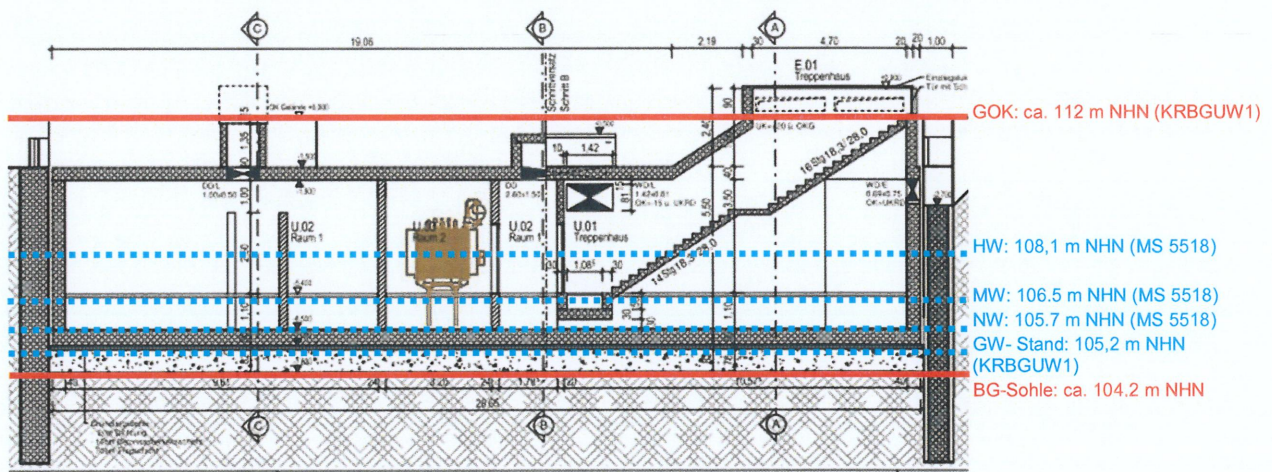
Auszug aus Bauwerksübersichtsplan inkl. GW-Stände (Anlage 3.4)
